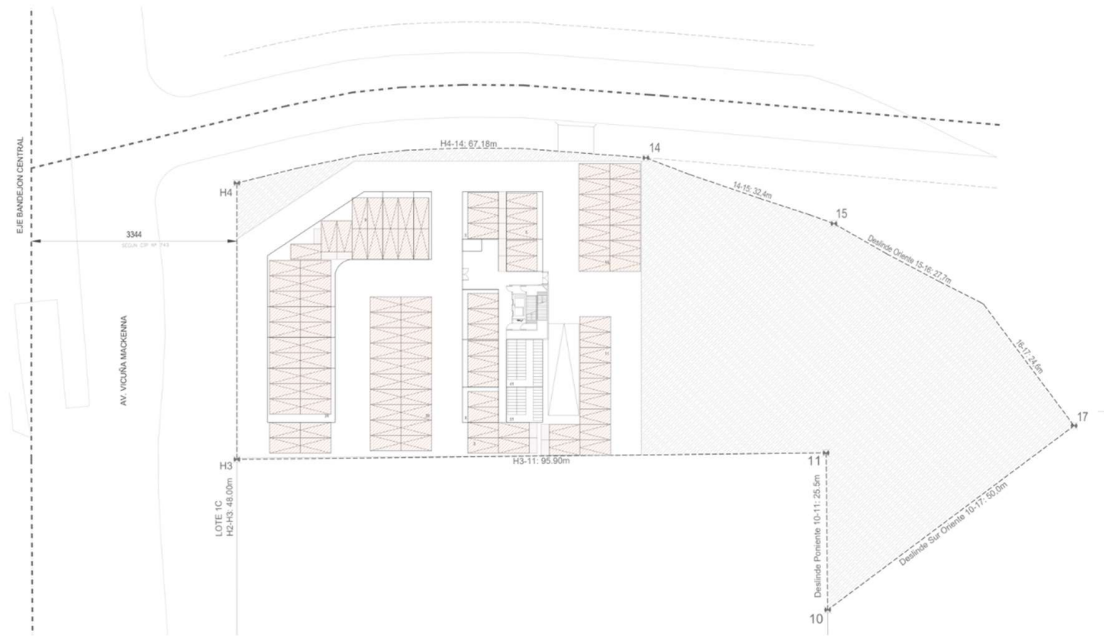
Planta piso -4. Fuente: Elaboración propia.
